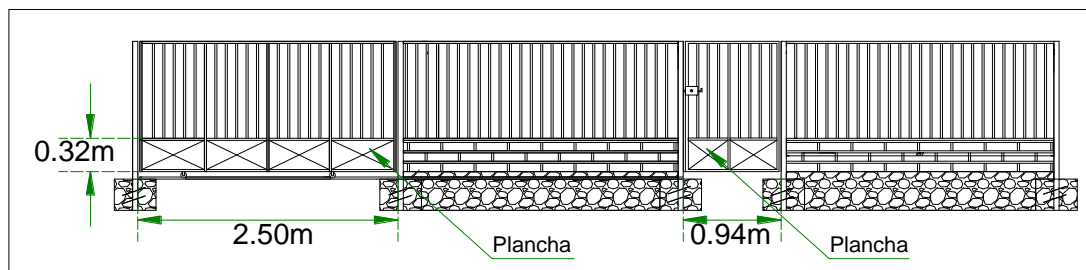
Detalle Plancha Laminado 1,5x1000x3000 mm Fuente: Propia
